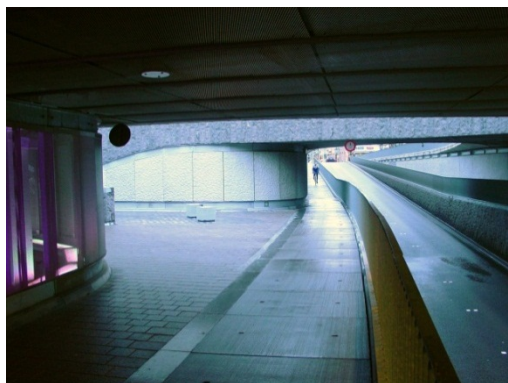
Tunnel onder spoorweg – Doorniksestraat Kortrijk
